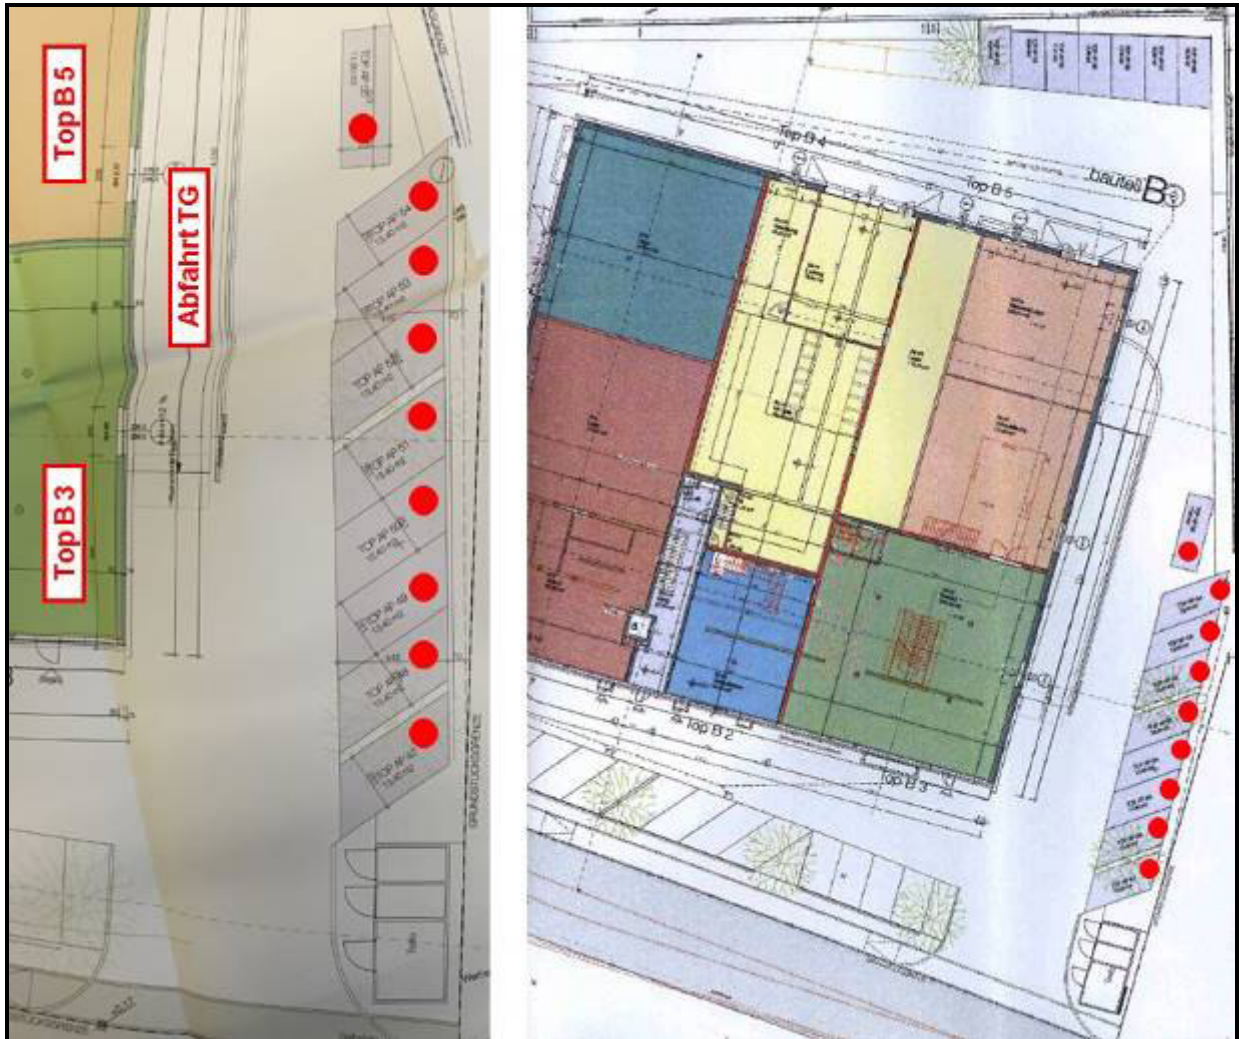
Lage und Grundriss der KFZ-Freistellplätze
